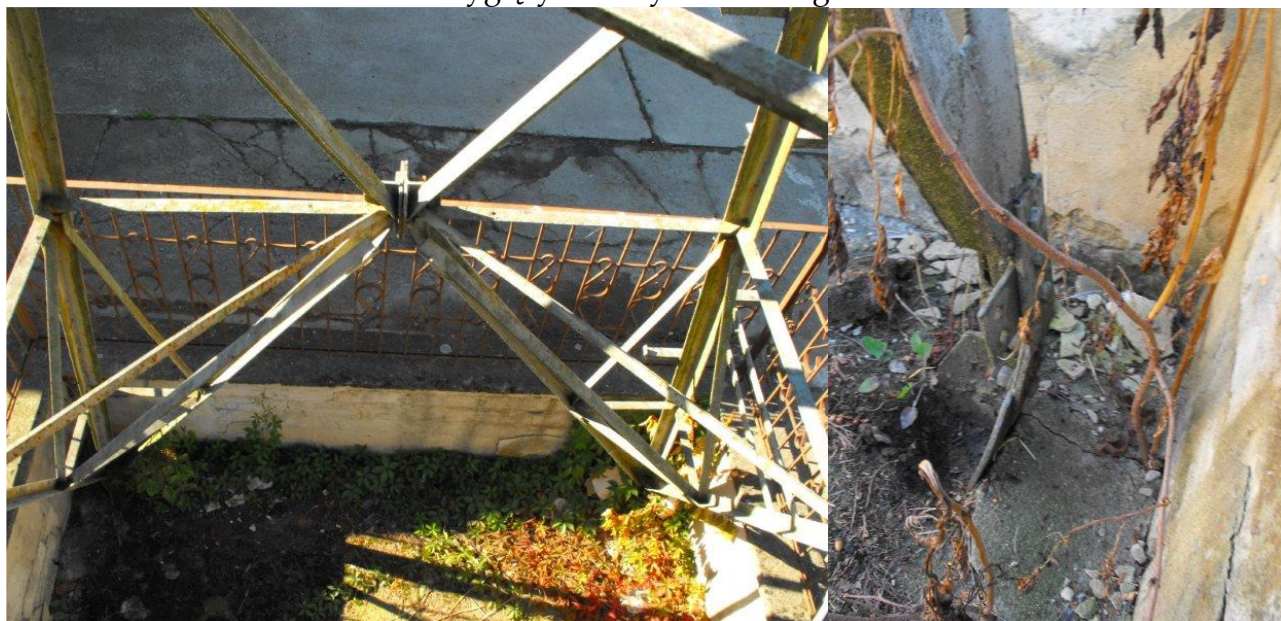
Korozja kotwy fundamentowej + spękania tynku ściany oporowej
